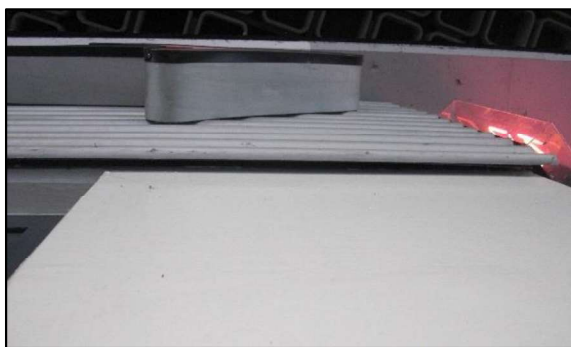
Spaltenstruktur hinter einer Fassadenverkleidung an einem der Gebäude (GSS)
